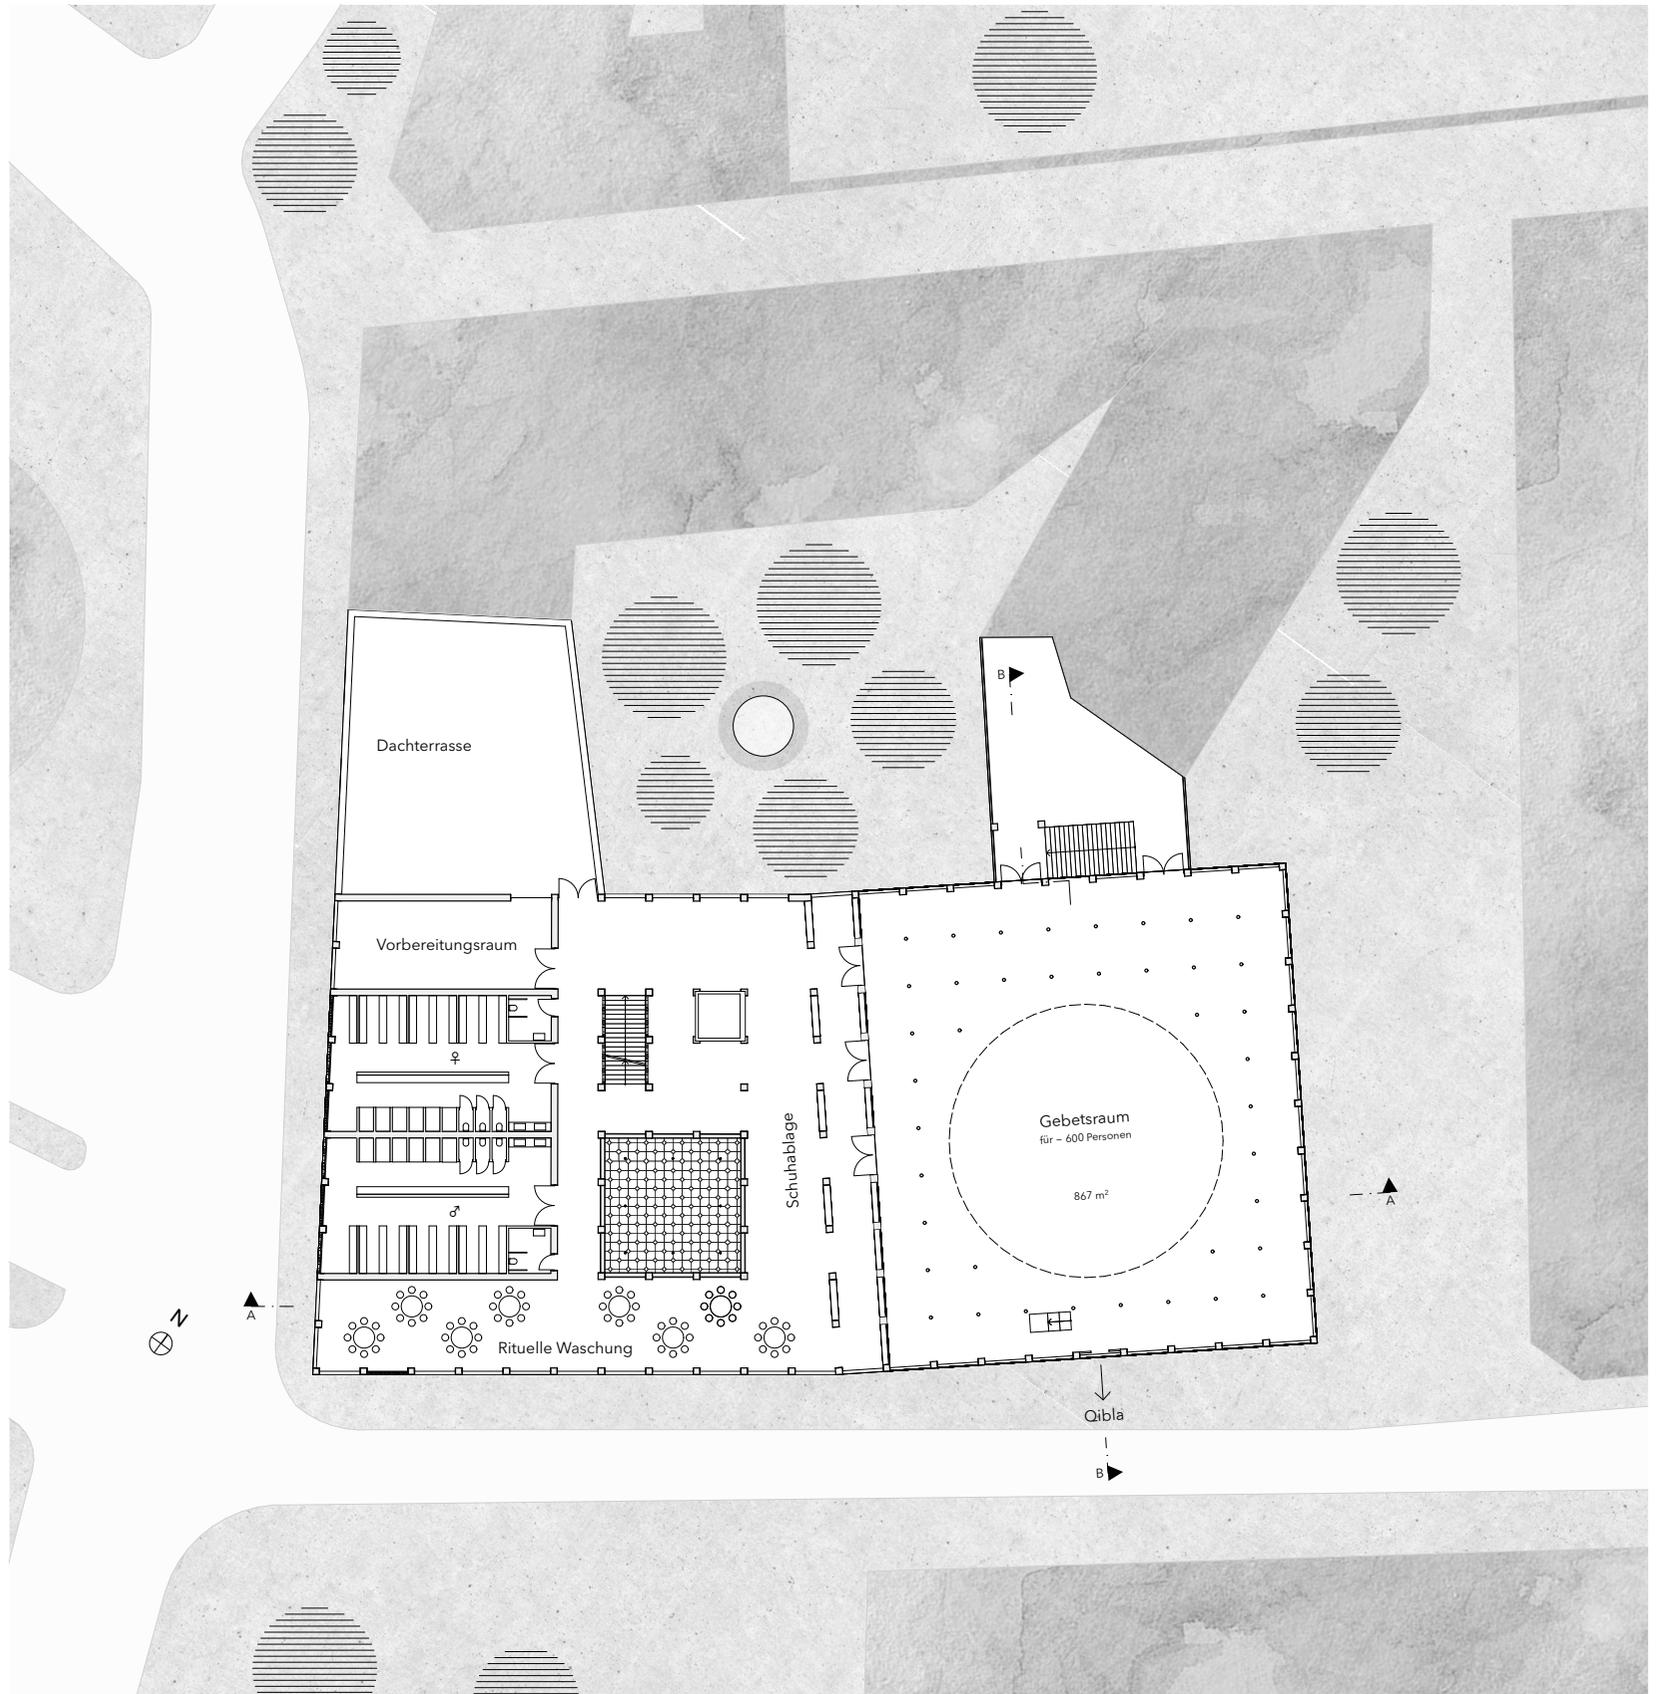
Grundriss Ebene 4 | 1:500
